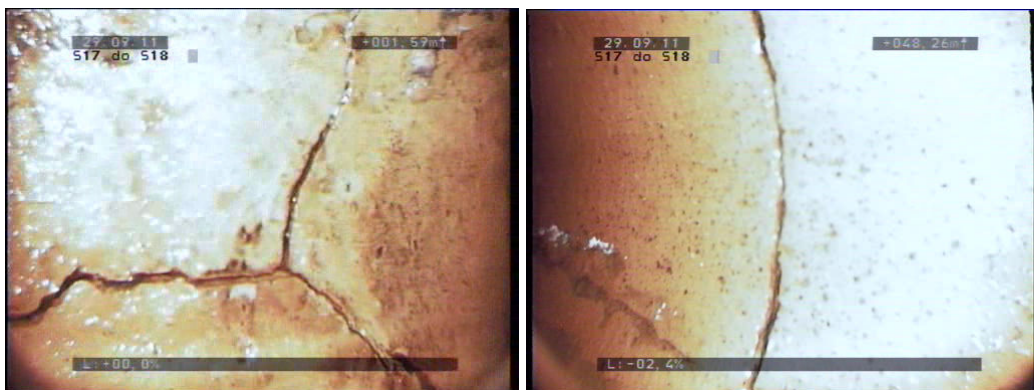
Infiltracja wód gruntowych poprzez nieszczelne złącza rur
